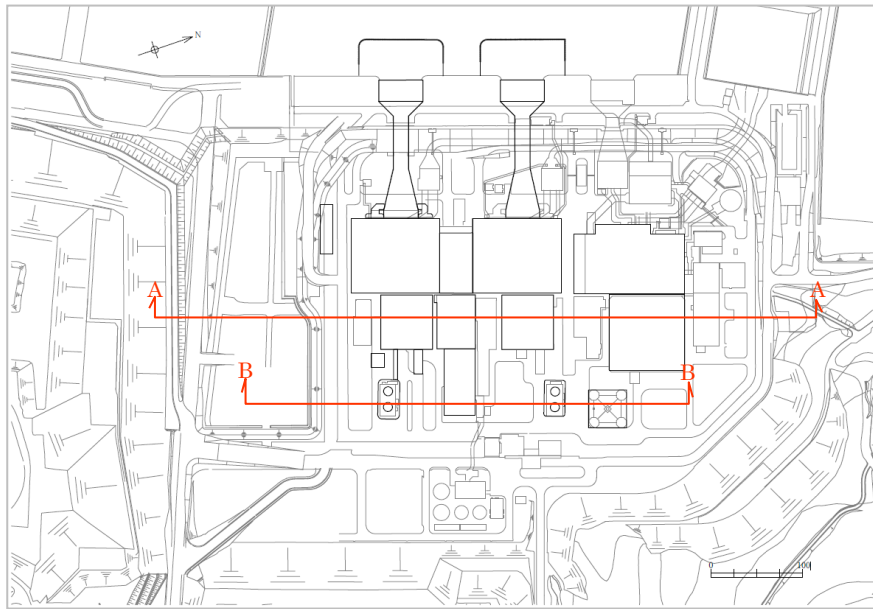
汀線平行 地質断面図 (原子炉建屋炉心中央) (A-A断面)
